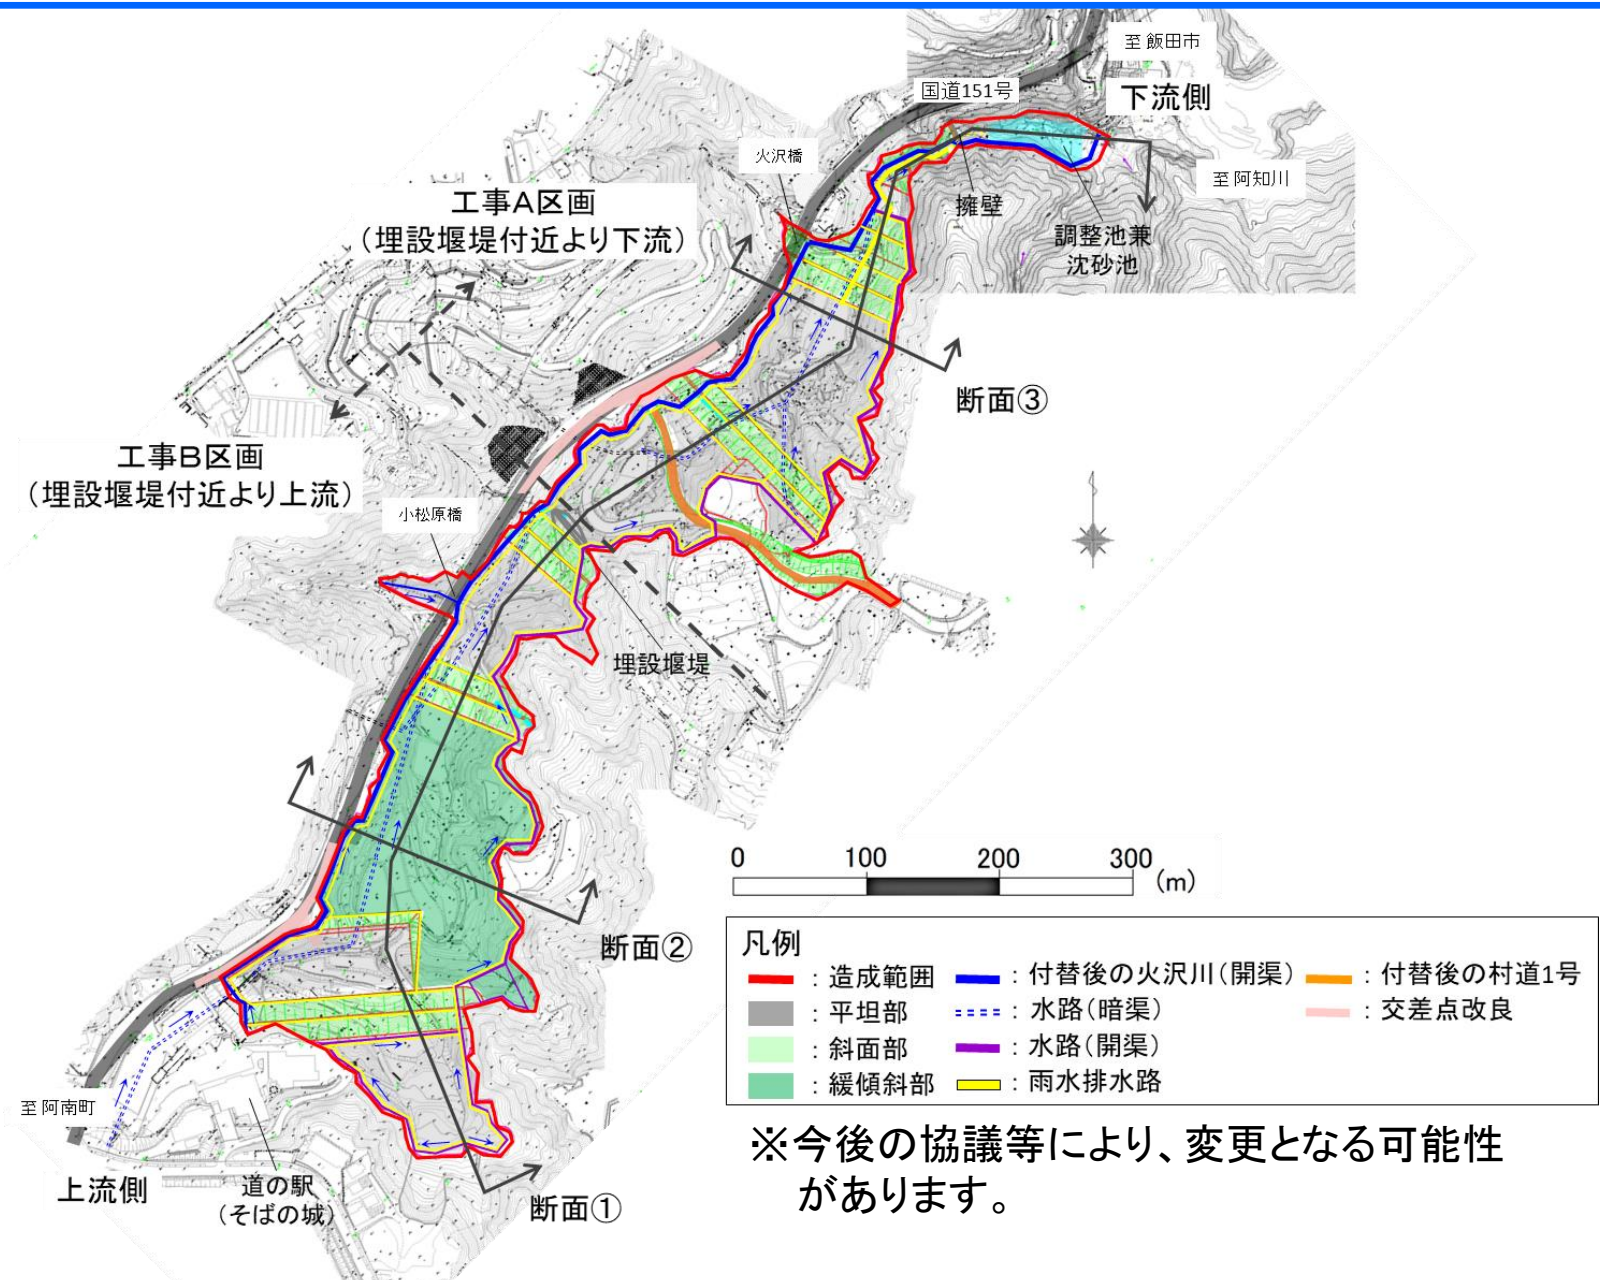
(1) 発生土置き場(睦沢)計画地における計画平面図
